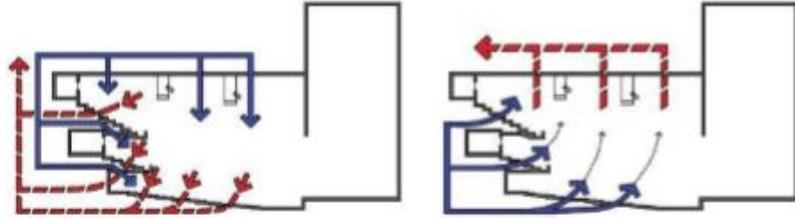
Contoh Aplikasi Ruang Kontrol
